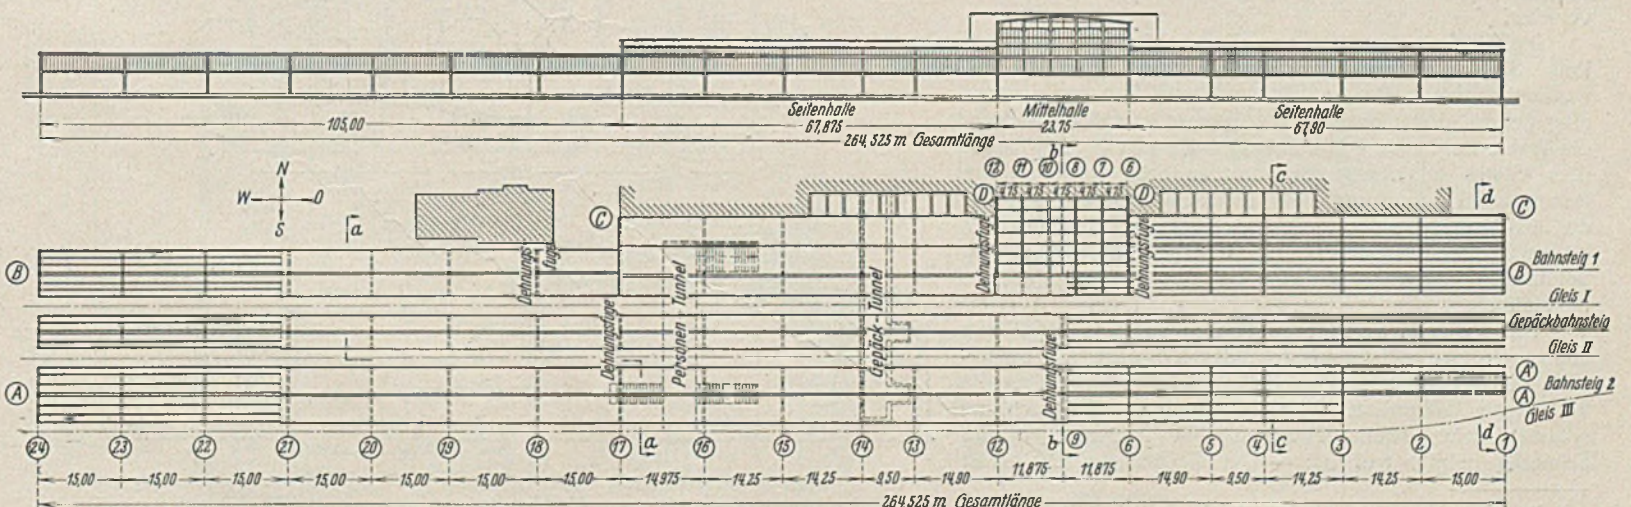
Ausführungsentwurf. Längsansicht und Grundriß.
